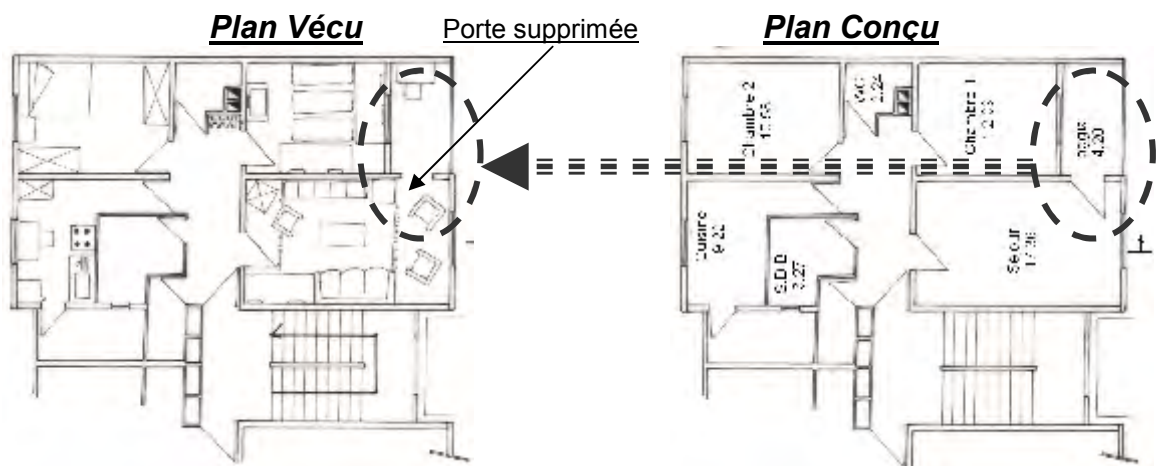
Exemple concret de l'expansion dans le Séjour. 3^{ème} Variante.
